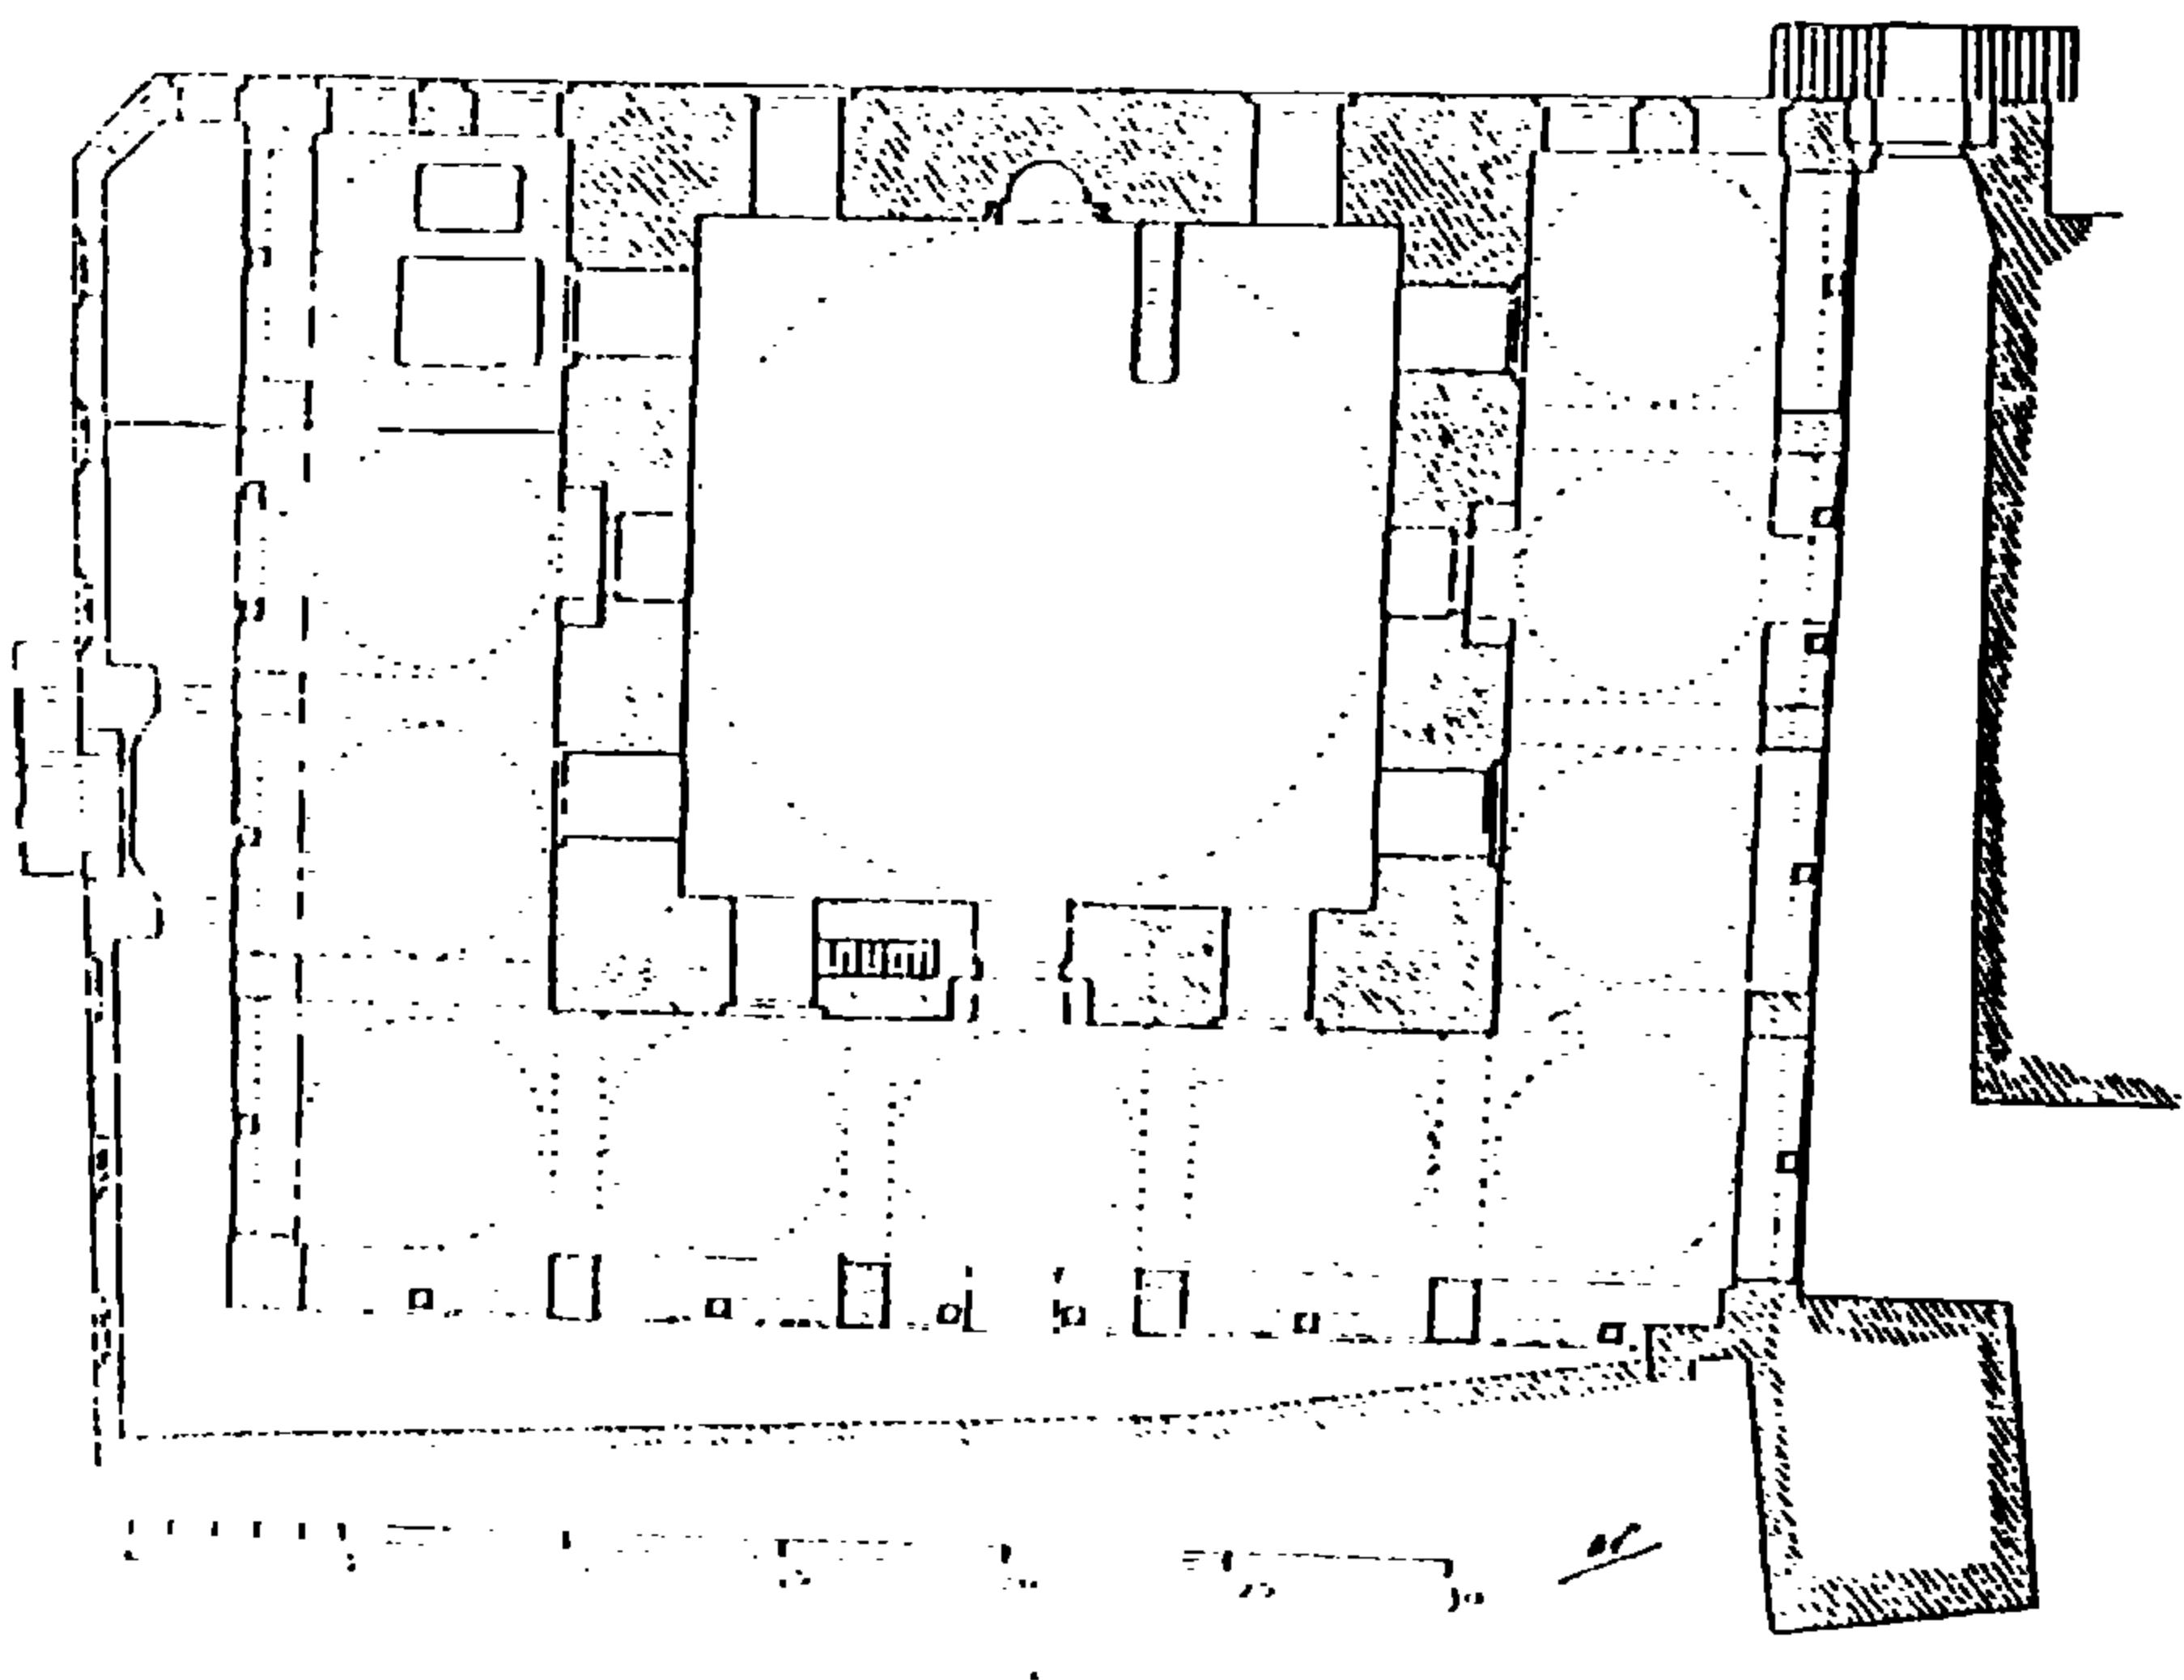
المقطع الأفقي لجامع أمد كنخدا العزب
